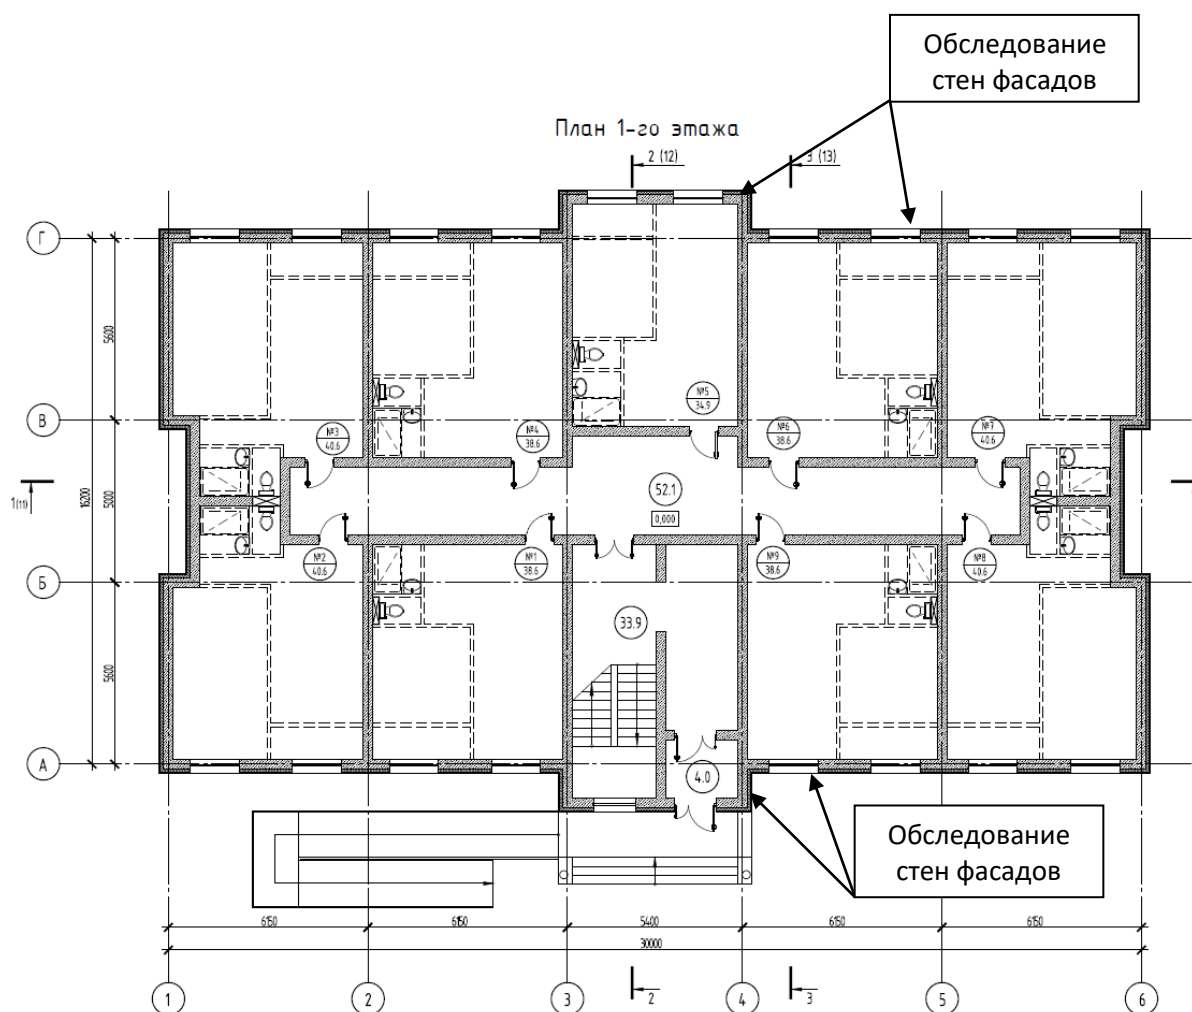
План на отм.0,000 (первый этаж). Обследование фасадов
